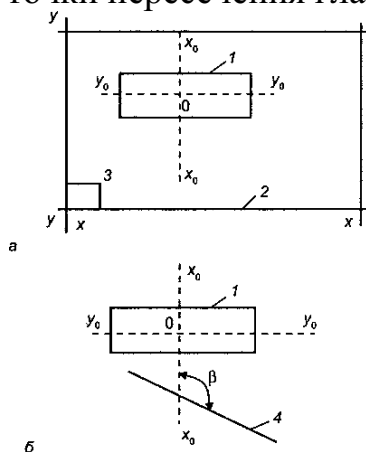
Способы переноса на местность основных осей зданий: а — на основе строительной сетки; б — на основе красной линии; 1 — здание; 2 — строительная сетка; 3 — оси условной координатной сетки; 4 — красная линия
